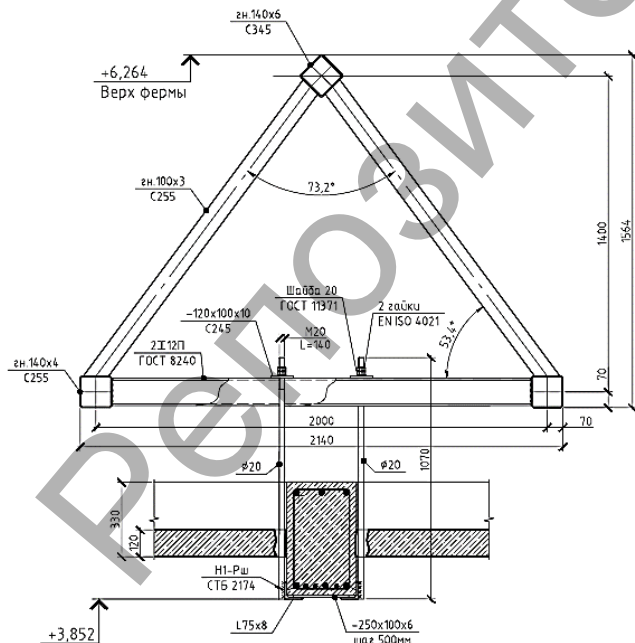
Конструктивное решение конструкции усиления чердачного перекрытия
